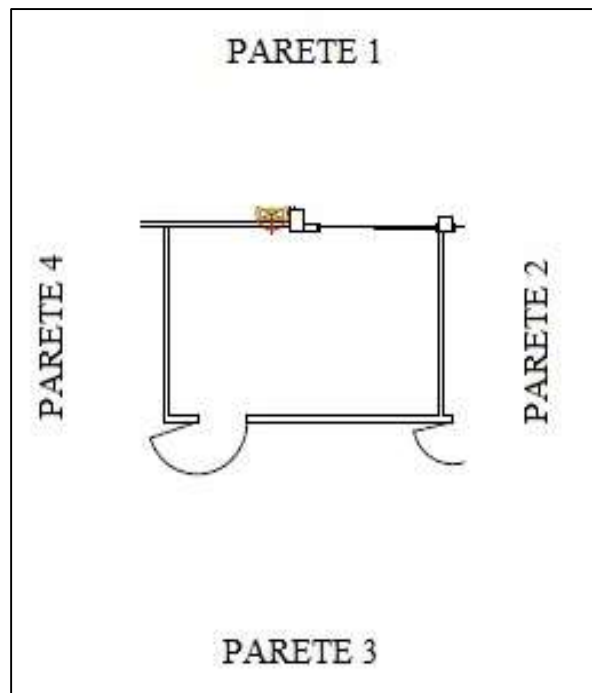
Planimetria dell’Aula Sostegno oggetto di misurazioni
